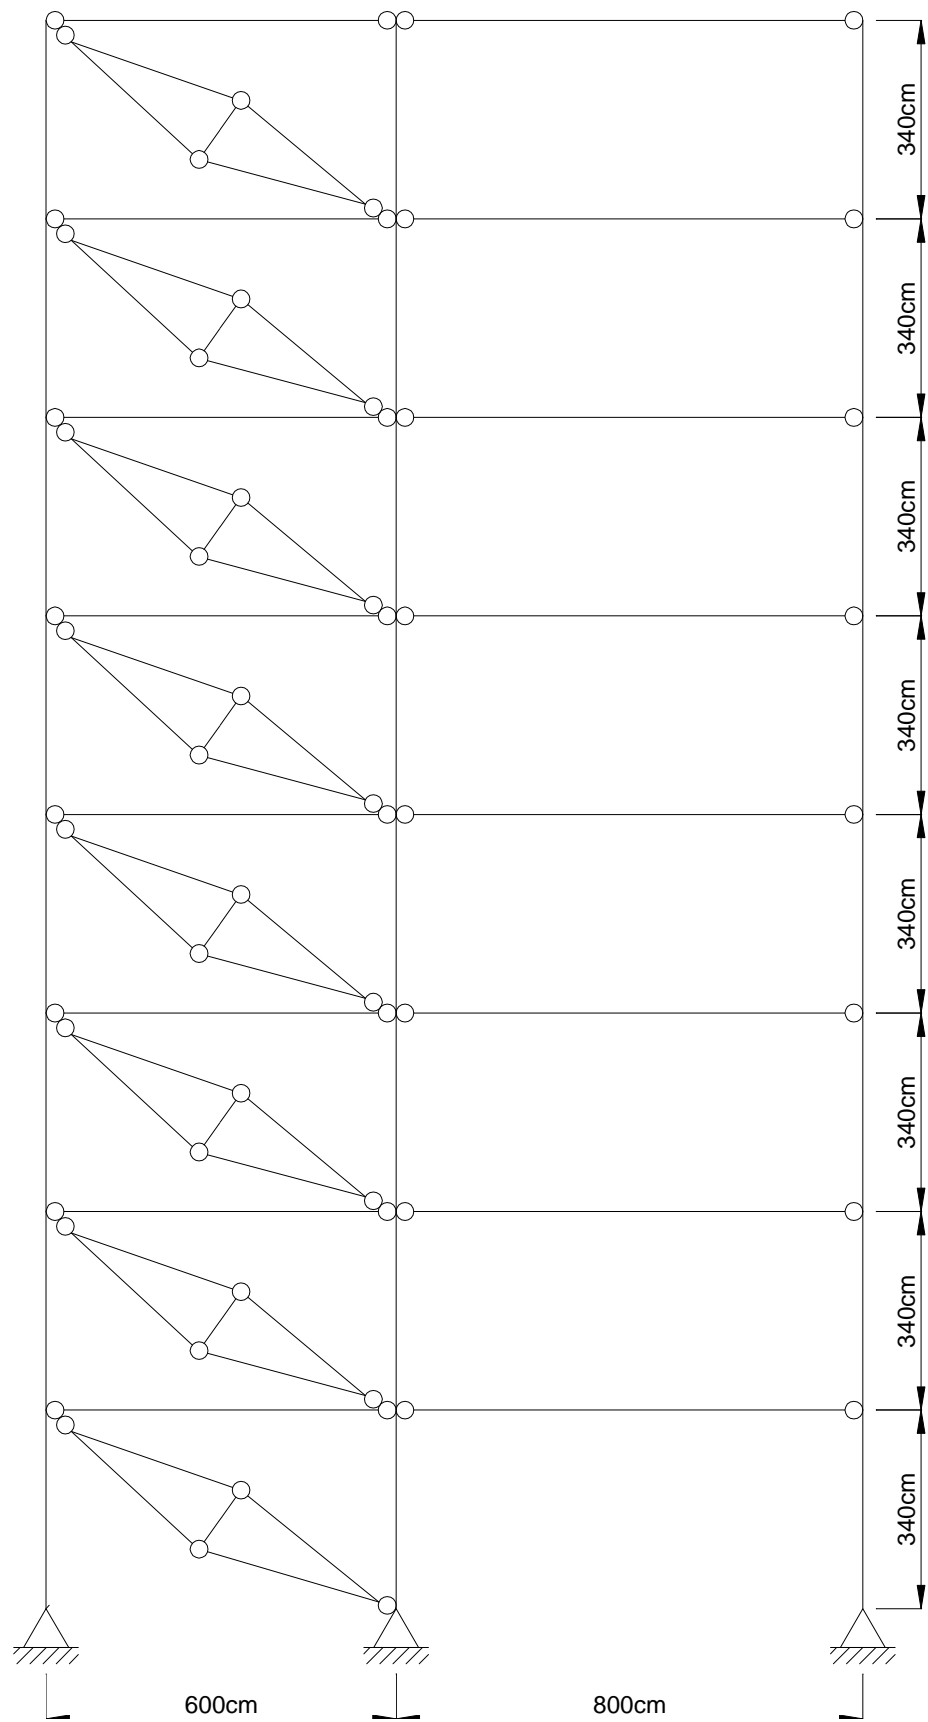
Tipologia utilizada no pórtico plano contraventado por painéis de alvenaria do caso A3.
